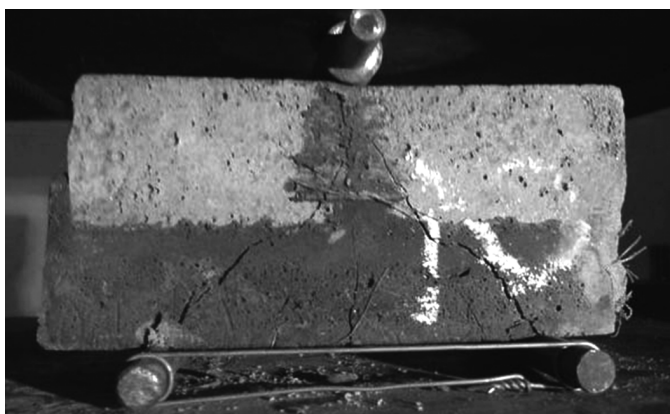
Схема проведения испытаний фибробетонного покрытия на изгиб:
